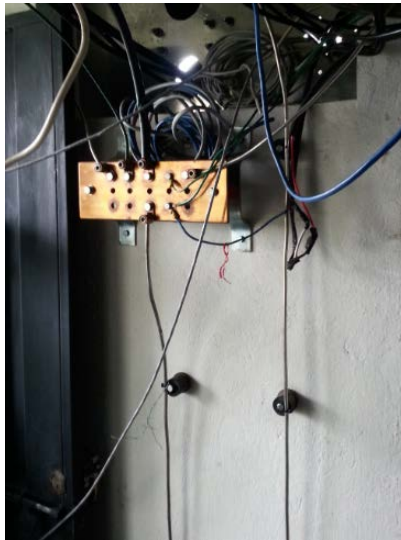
Protección contra rayos instalada en el interior de la caseta de Miravalle
